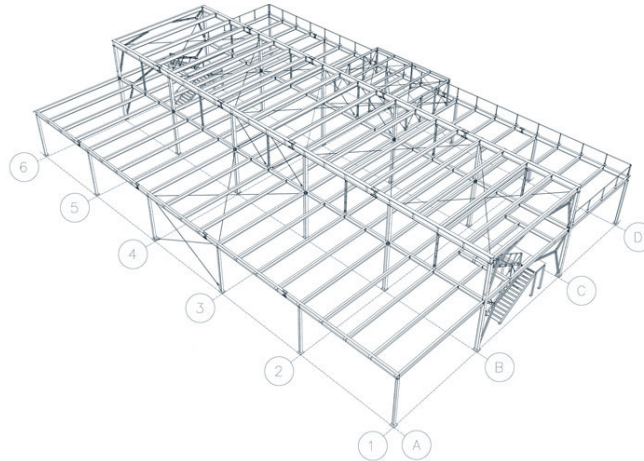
Omes: struttura portante in profilati d'acciaio a giunti imbullonati
